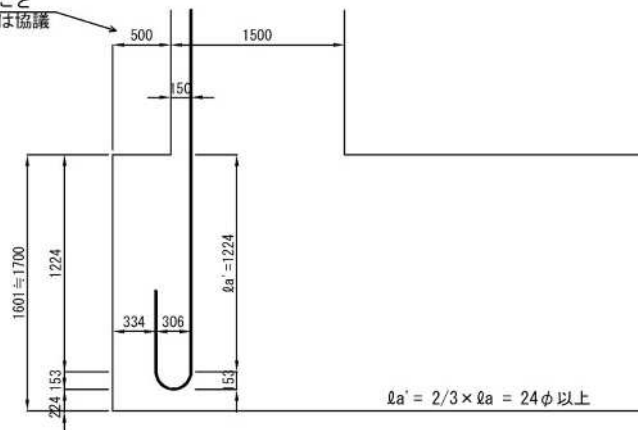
柱主鉄筋のフーチングへの定着 (要領 図-3.78)
